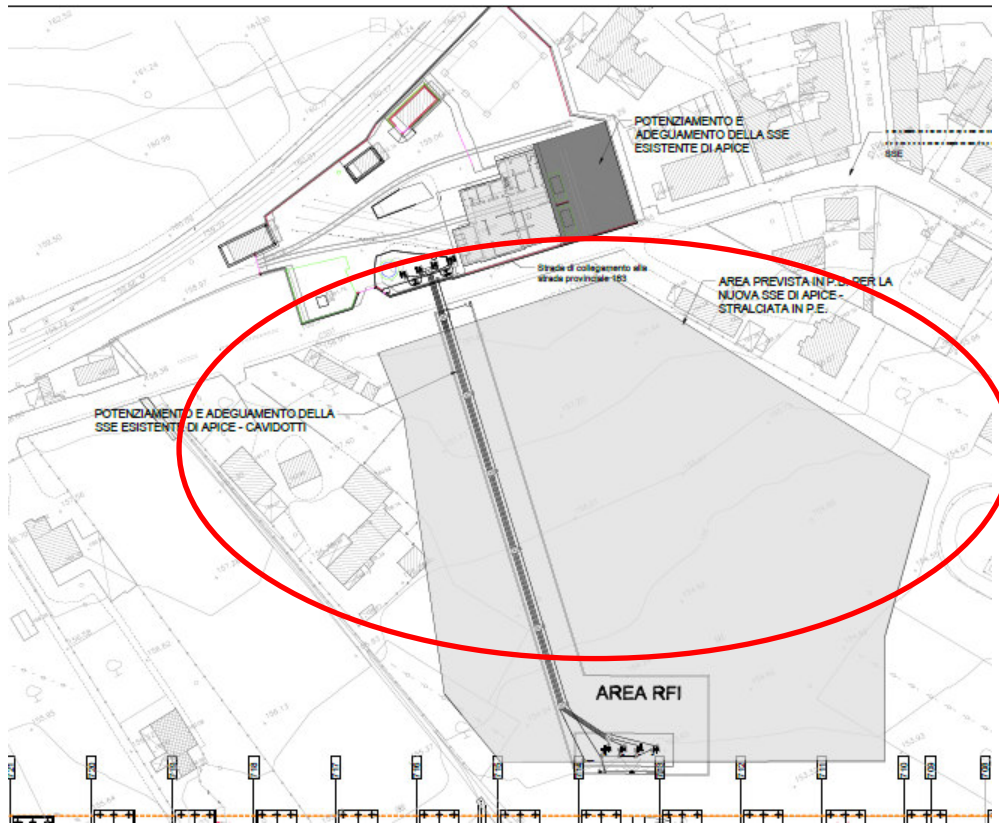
Planimetria della sistemazione del piazzale SSE Apice come da prescrizione in oggetto
